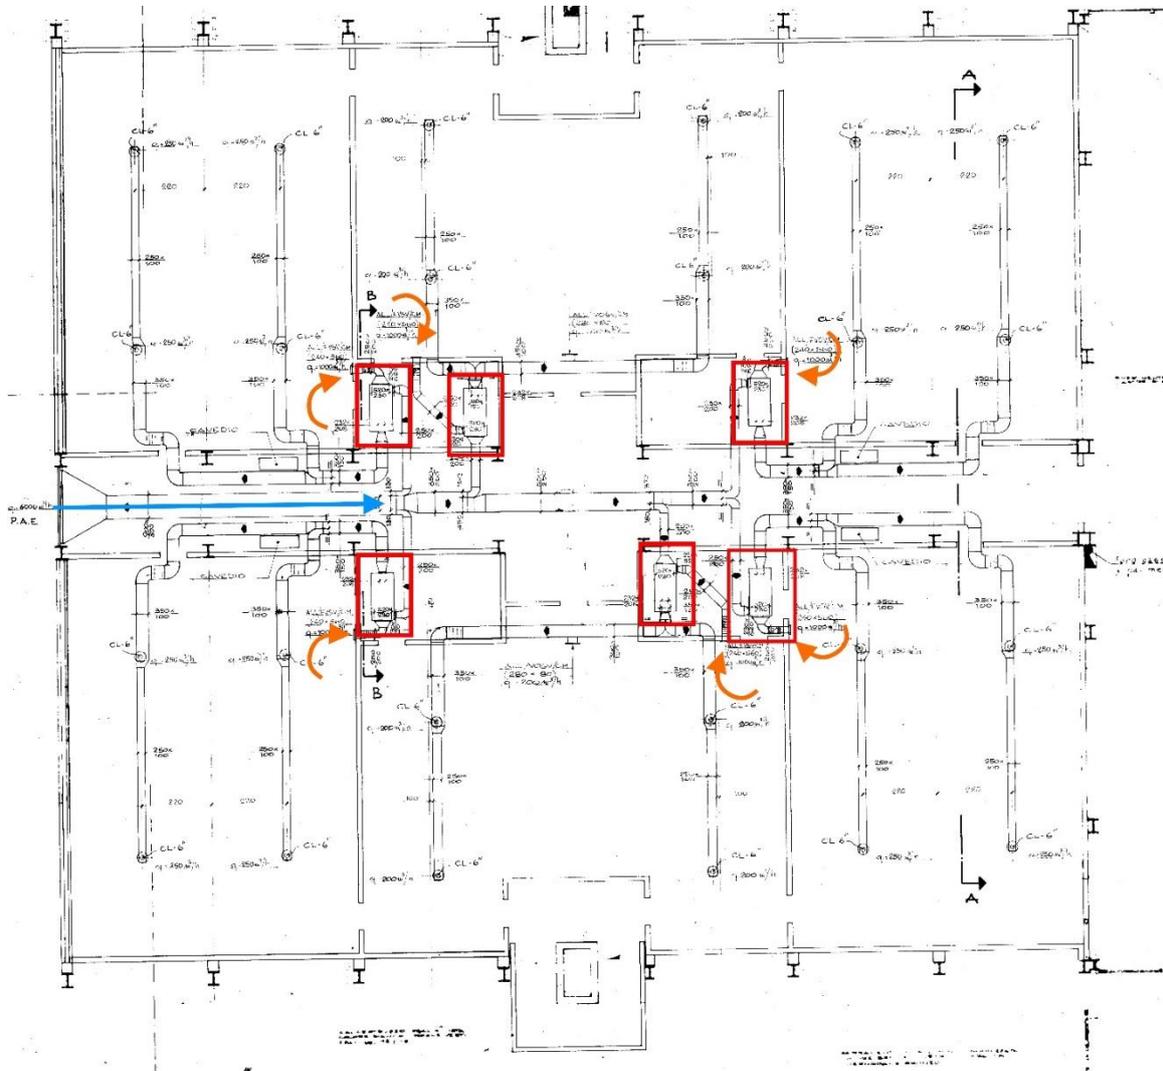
Impianto di termoventilazione di un piano tipo Ala Est Didattica
